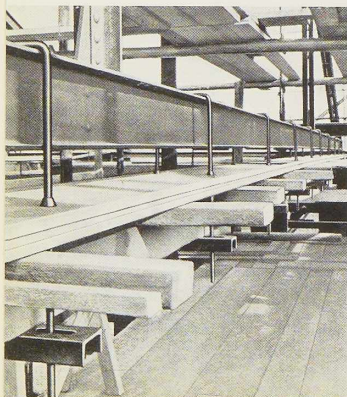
et 687. Vue d'une poutrelle prête à être enrobée. Schéma du dispositif d'étrier entourant la poutrelle et noyé dans le béton.
